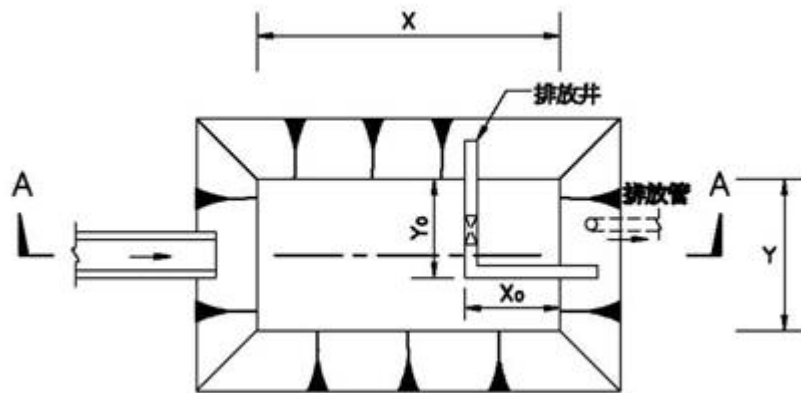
施工中滯洪沉砂池平面圖(重力式)
